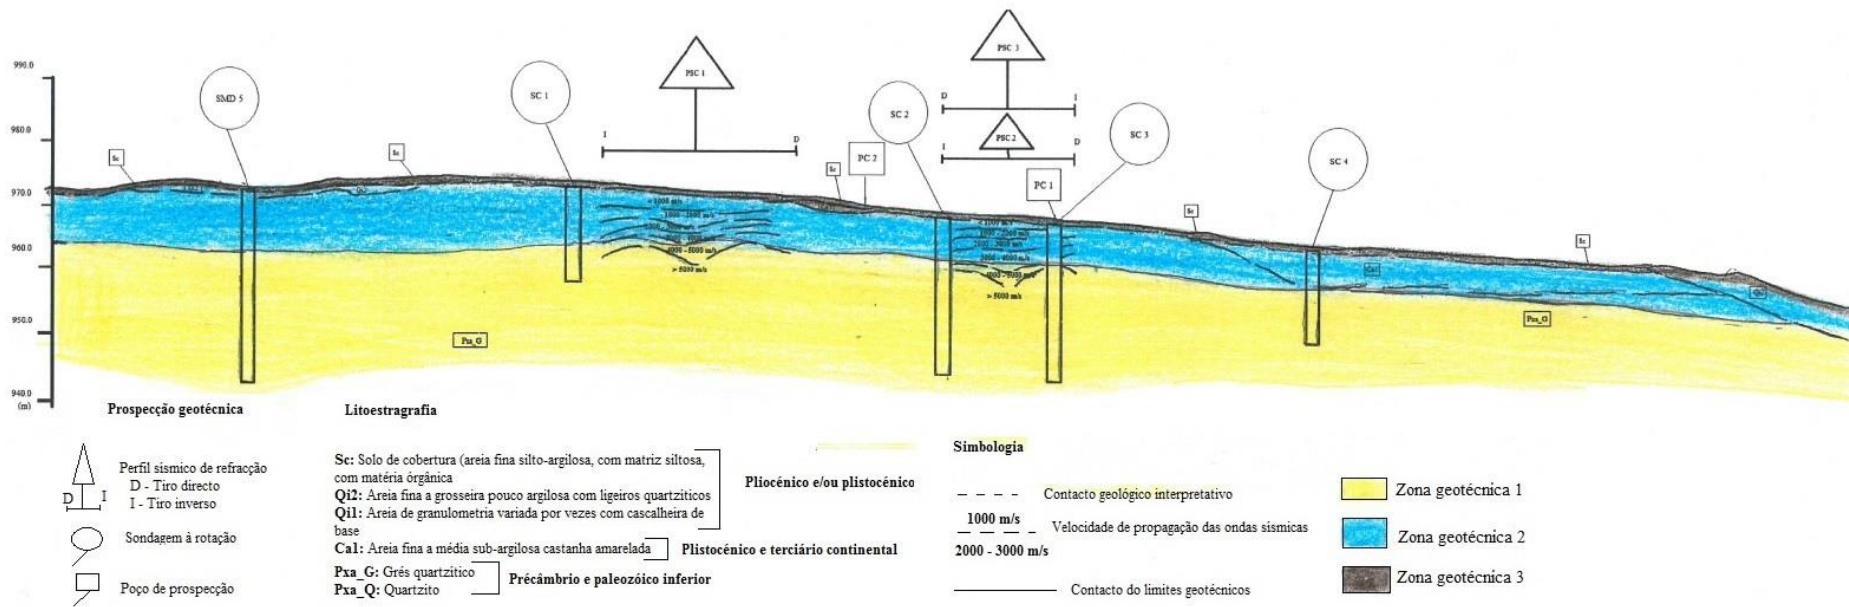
Perfil geotécnico longitudinal pela central e órgãos hidráulicos (Escala V: 1/250, H: 1/500)
